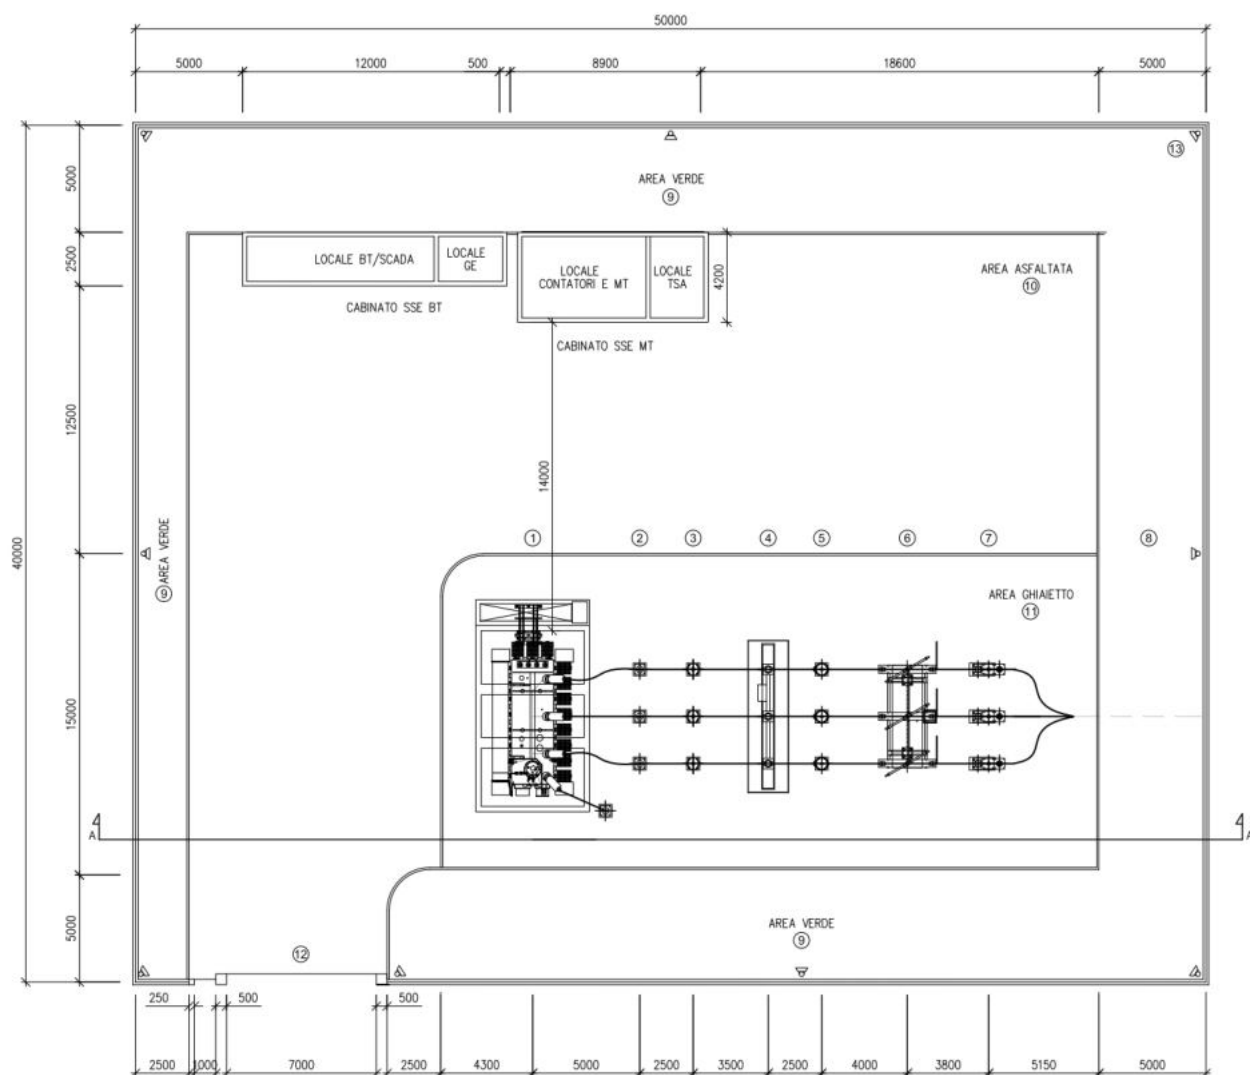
Estratto dell'elaborato Cod055_FV_00052_BED-PIANTE PROSPETTI E SEZIONI SSE.
